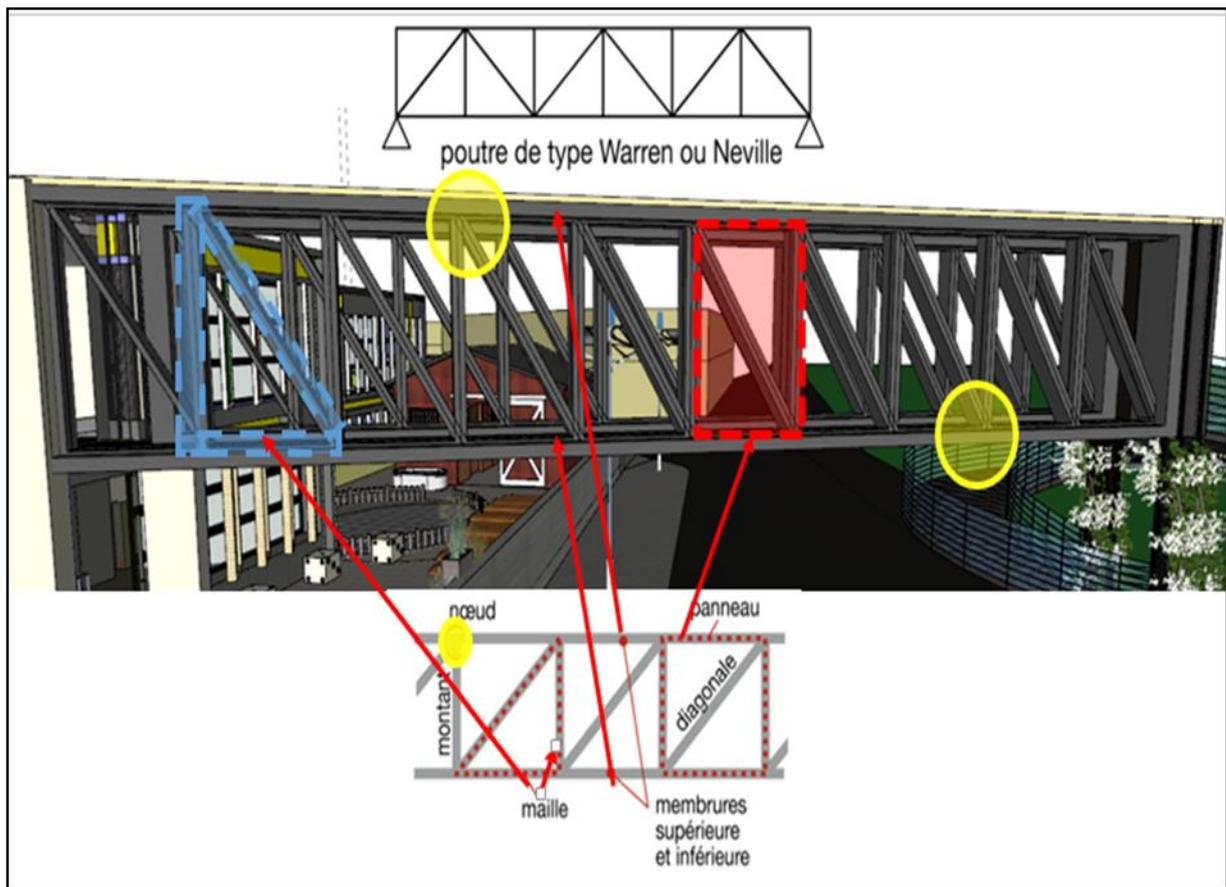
type de poutre treillis utilisé dans la passerelle. Source : auteur
